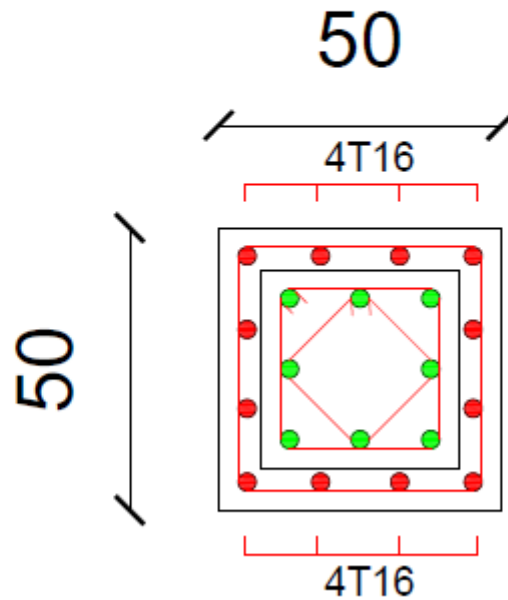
schéma ferrailage poteaux 50x50.
